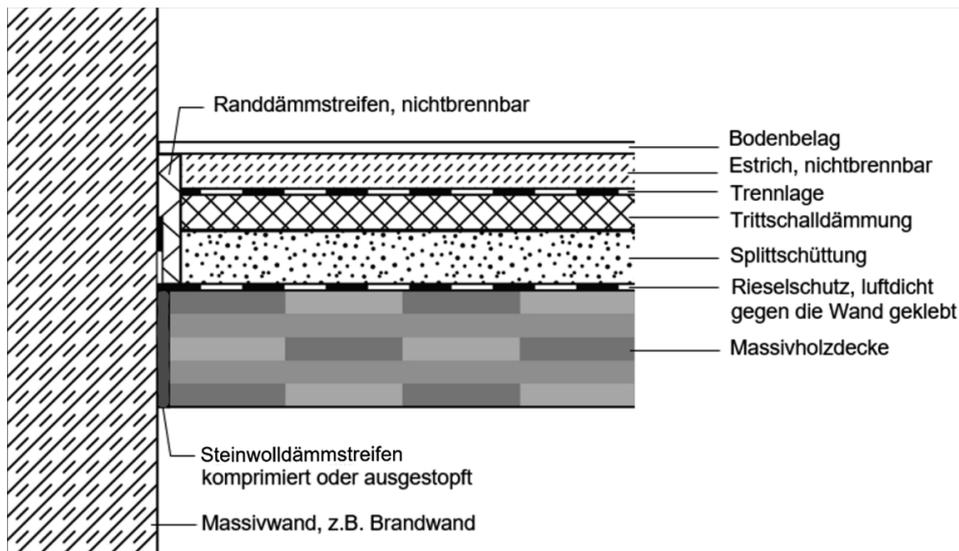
Bauteilanschluss unbekleidete Massivholzdecke an Massivwand (Vertikalschnitt)
